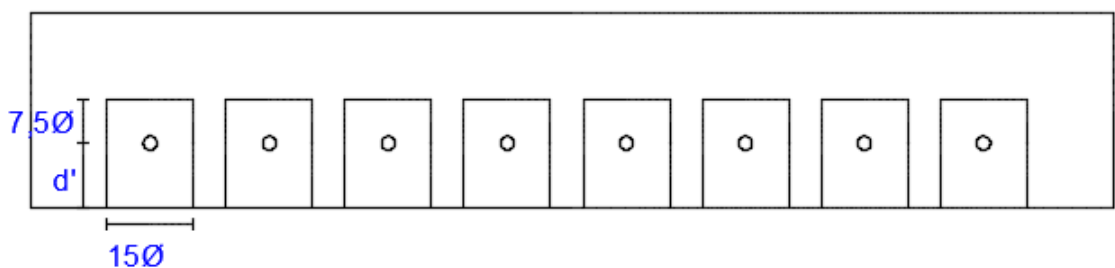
Modelo para determinação da área de envolvimento da armadura.
